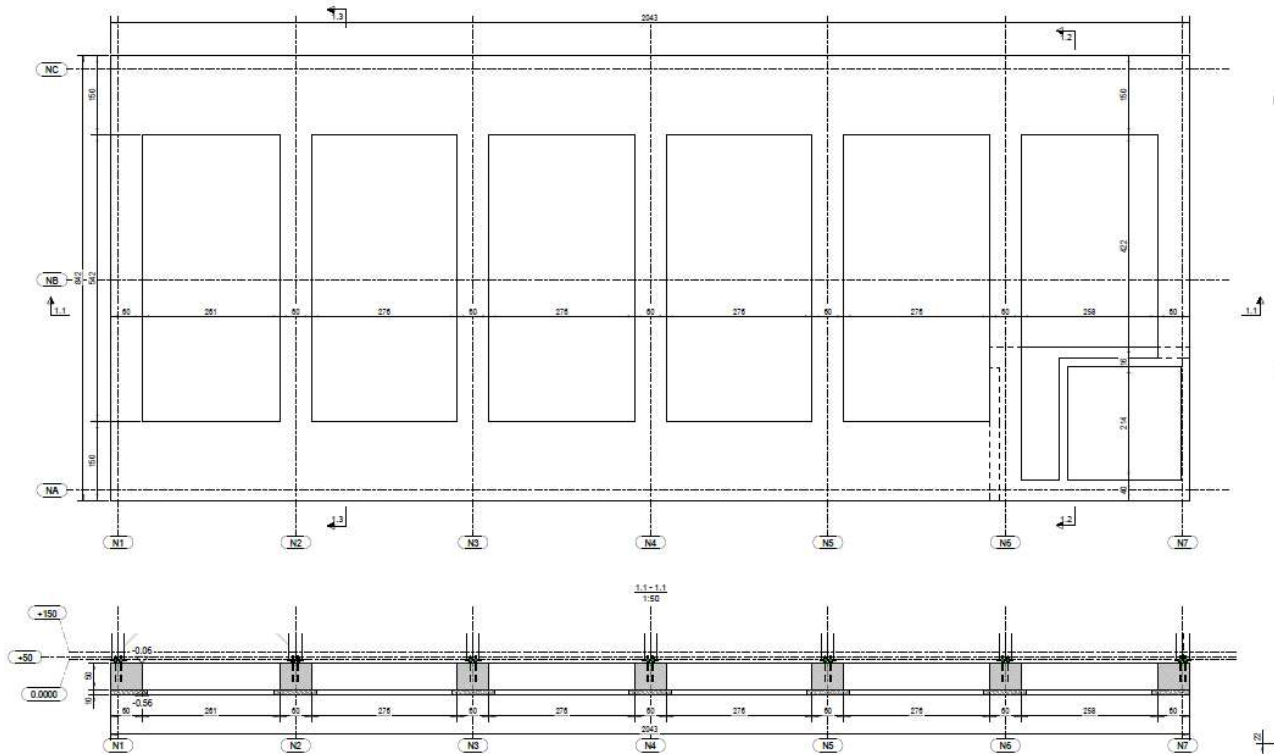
Ex Galoppatoio – pianta delle fondazioni Fabbricato 1
